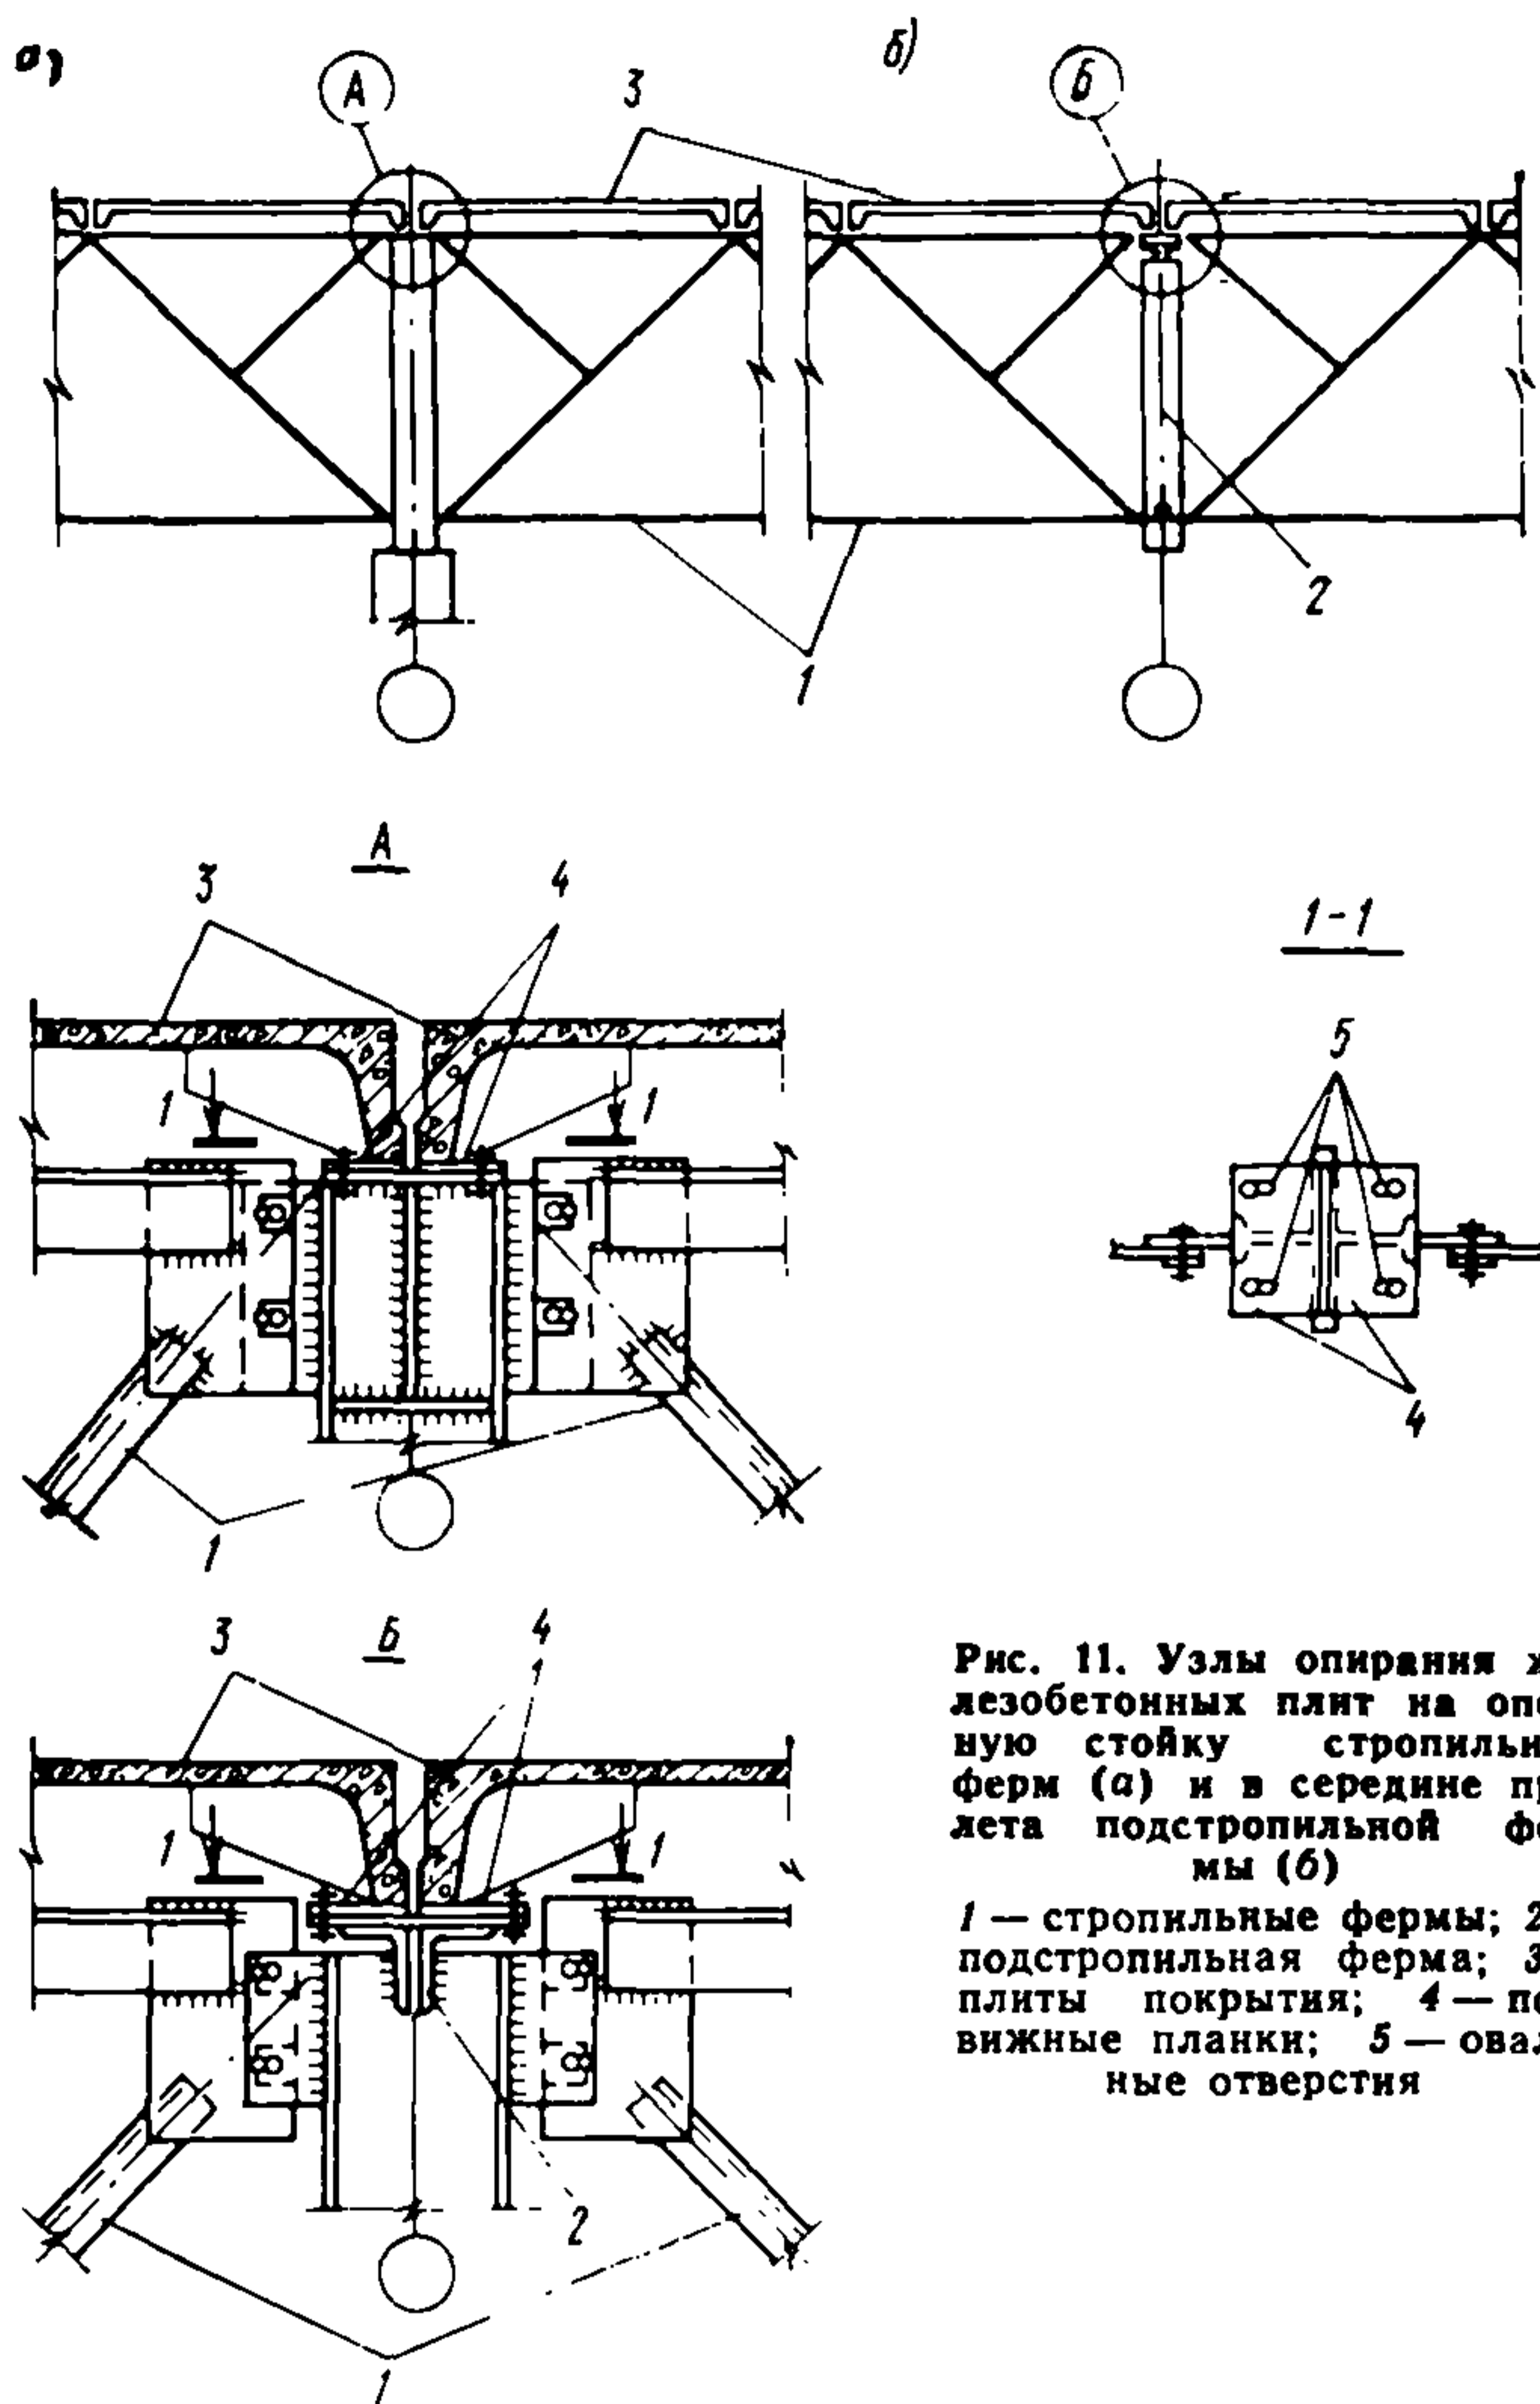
Узлы опирания железобетонных плит на опорную стойку стропильных ферм (а) и в середине пролета подстропильной фермы (б)
